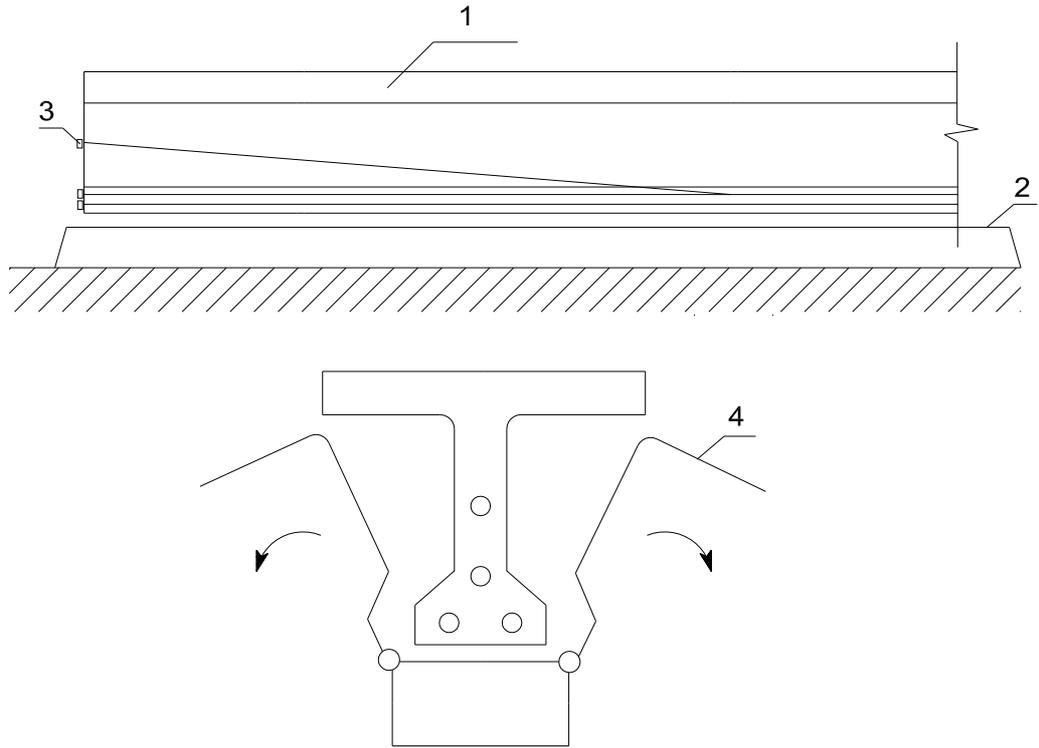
Схема изготовления цельнопролетной балки с натяжением после бетонирования: 1-бетонируемая балка; 2-стапель; 3-анкер; 4-боковая опалубка
